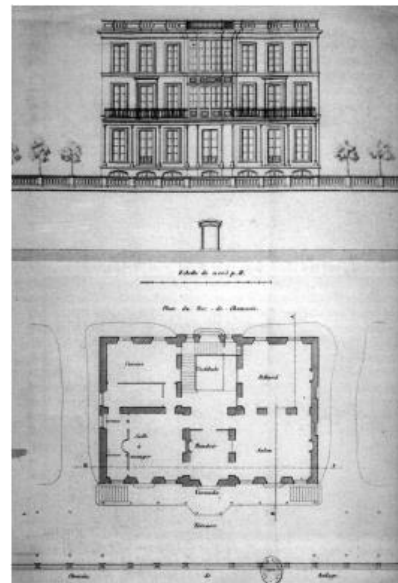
Planos de la casa construida según la patente de Wilkinson
